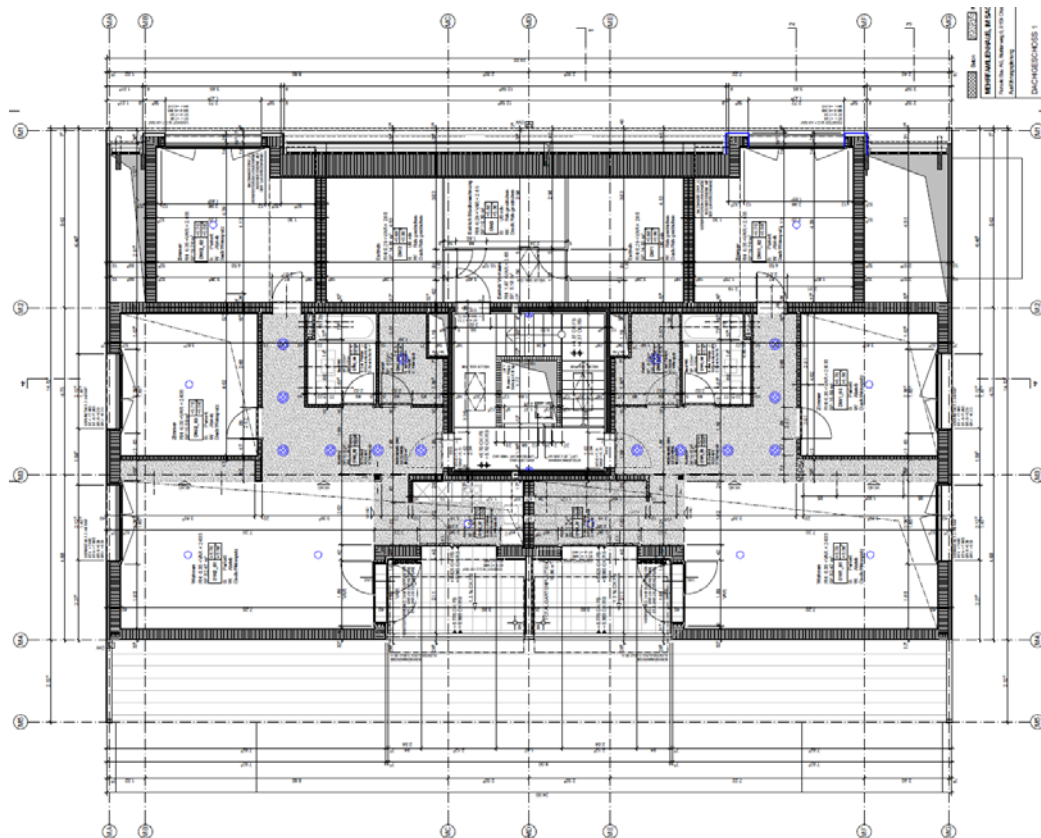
Grundriss Dachgeschoss 1 (Bild ZBF Architekten AG)
